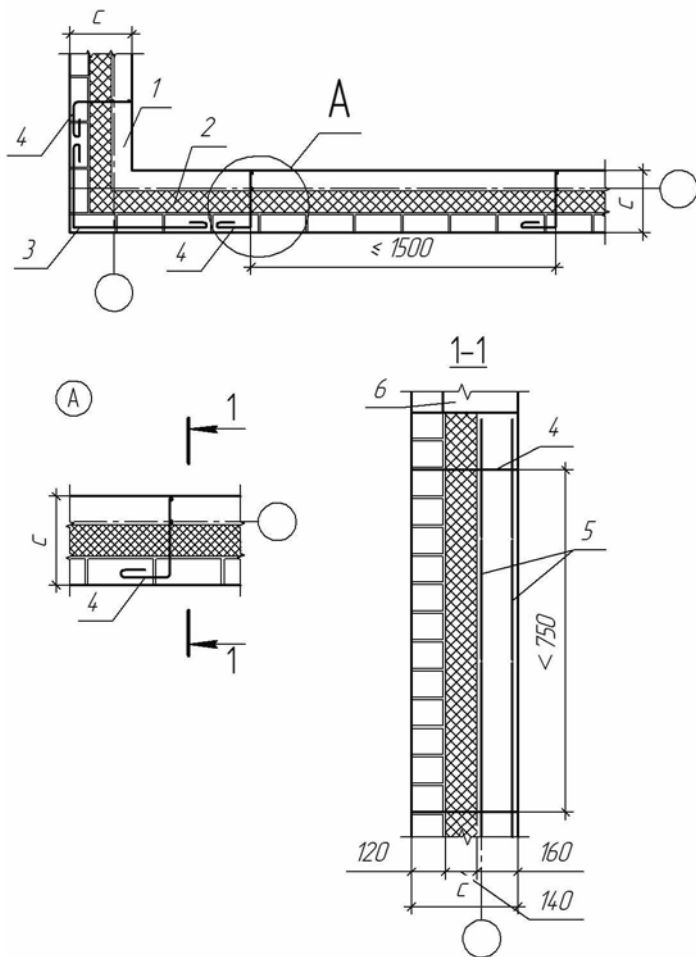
Схема плана и детали монолитной наружной стены малоэтажного дома с кирпичной облицовкой:
